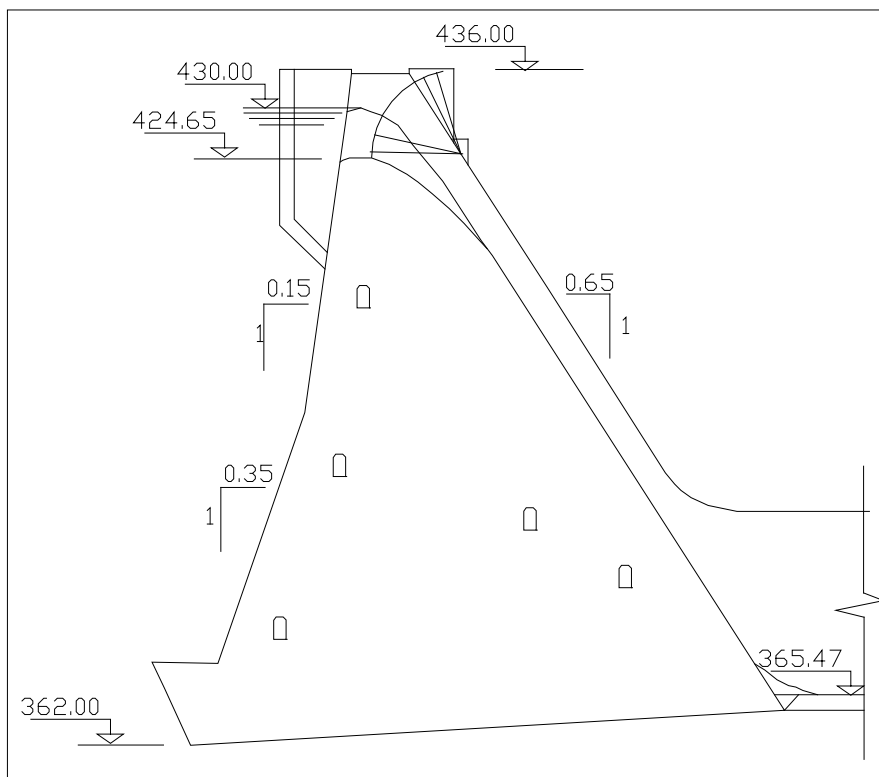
Sección transversal de la estructura de la presa Rialb. Escala 1:800.
